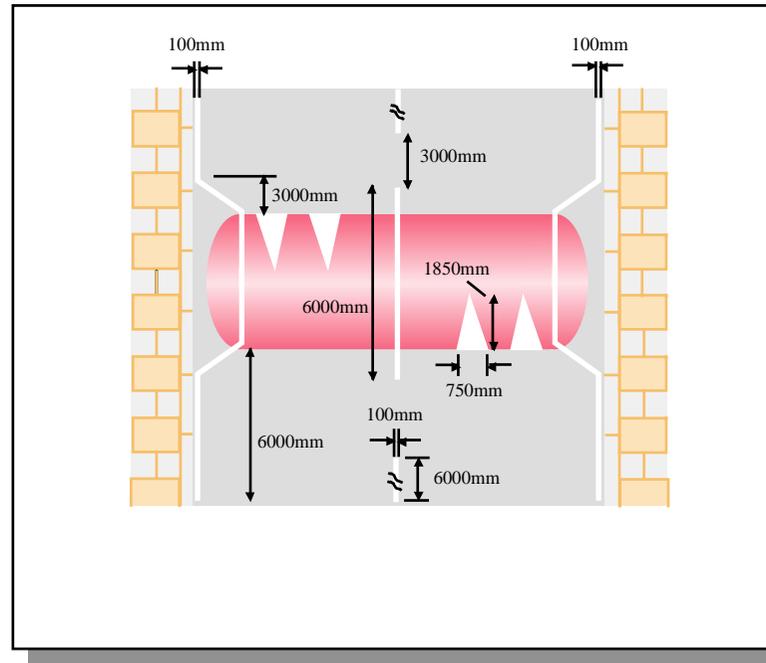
Detalhe da sinalização horizontal para ondulações de perfil circular conforme padrão adotado na Grã-Bretanha.
